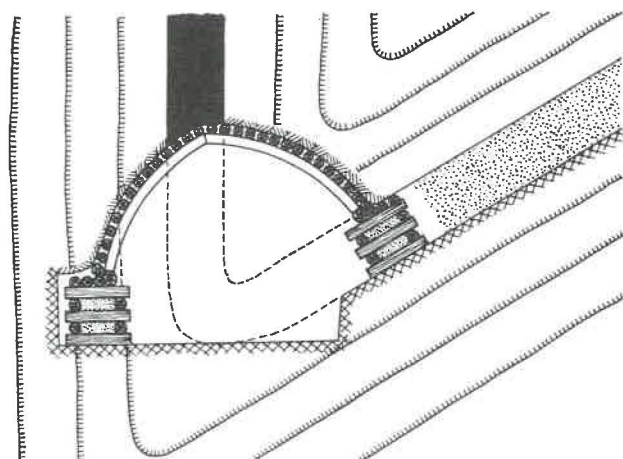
Voie de base en crochon de pied : soutènement définitif en cadres articulés sur piles de bois.
